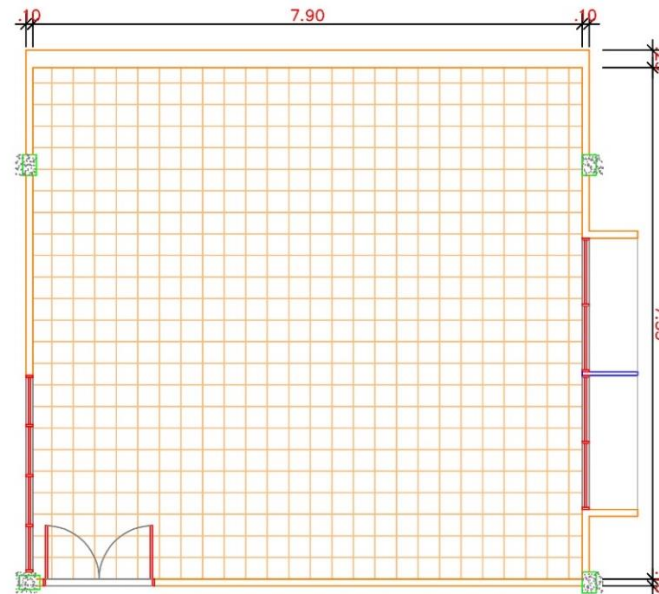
Planta baixa do primeiro pavimento - CEAMAZON.
